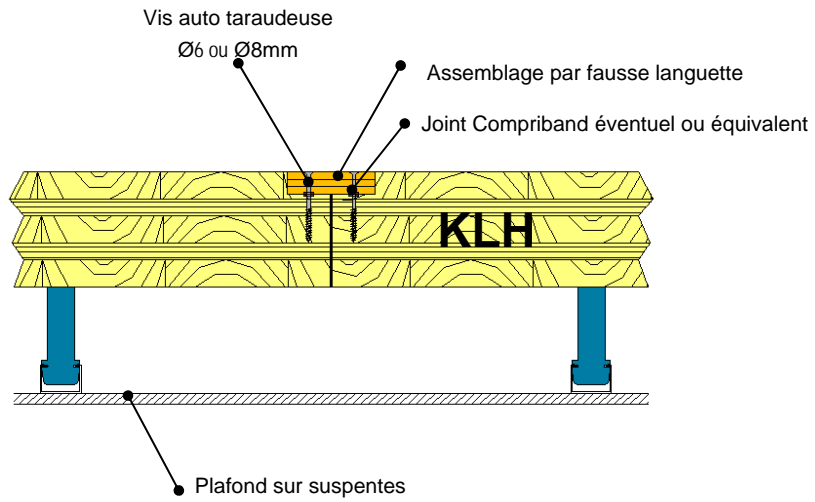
Coupe verticale jonction usuelles de planchers ou de murs
